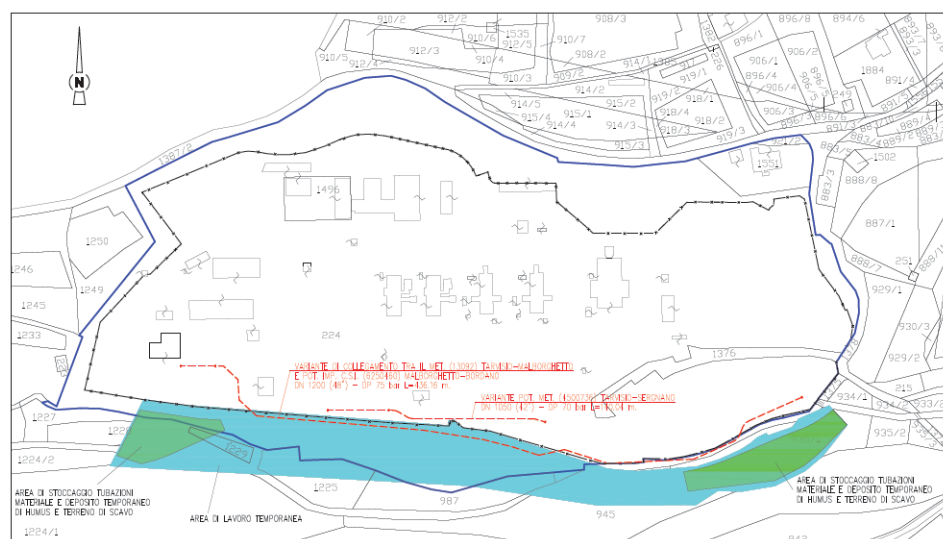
Stralcio della Planimetria Catastale dell'area della Centrale di Malborghetto Comune di Malborghetto – Val Bruna Foglio 9.
